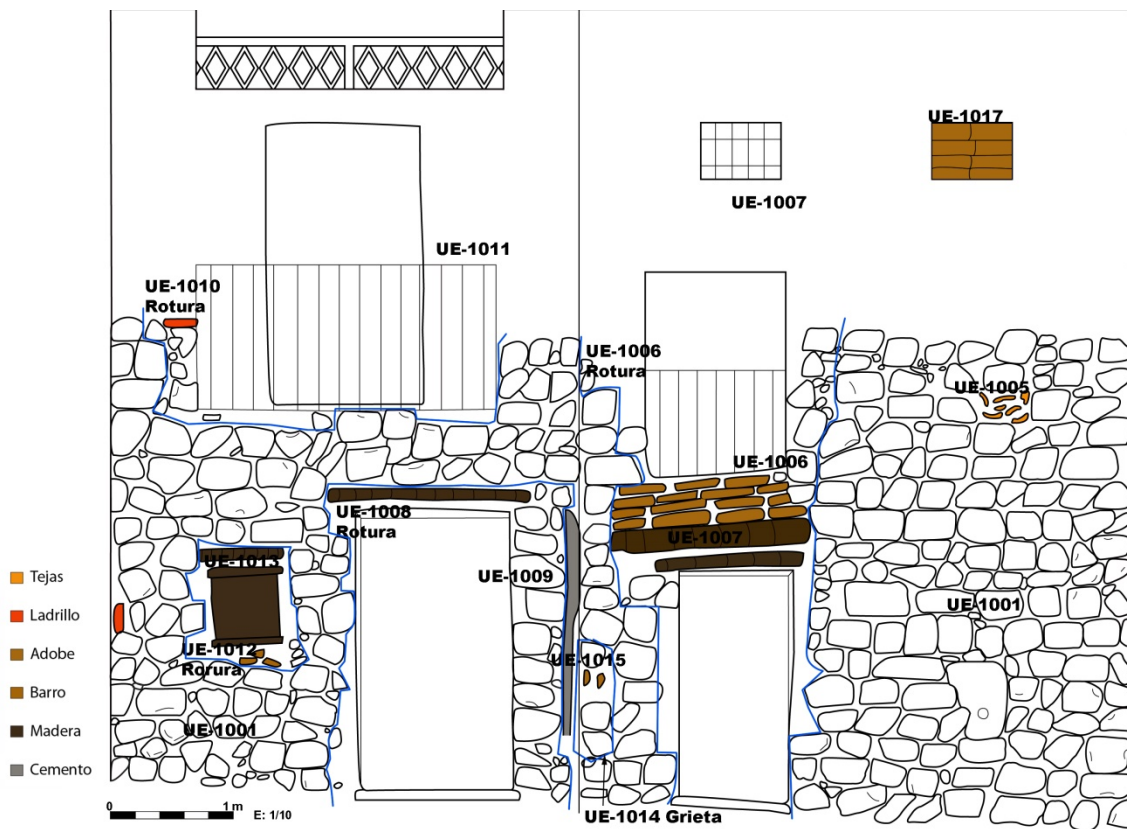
Planimetría de la fachada de las viviendas 45-47. Secuencia estratigráfica y análisis de las estructuras emergentes.
